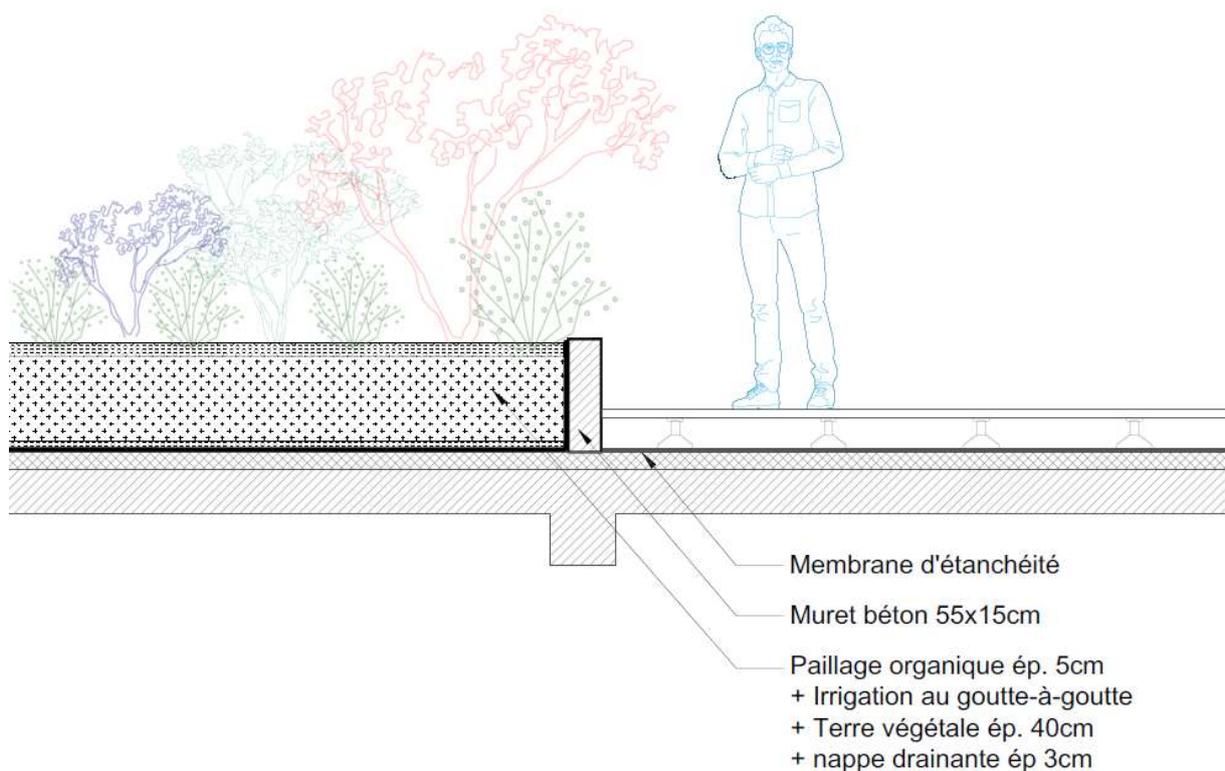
Coupe type d'un détail technique d'un muret de plantation sur jardin sur dalle d'un projet similaire de l'agence A+R (A+R paysages, 2020)
